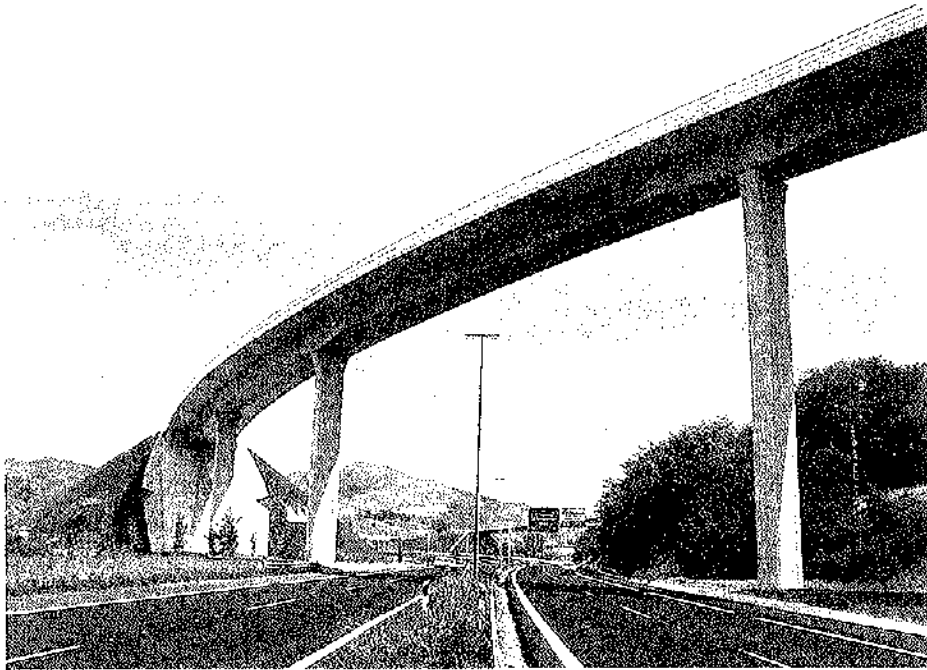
Autovía de Navarra-Guipúzcoa. Viaducto monocelular continuo, de canto variable, ejecutado totalmente, incluso pilas, con elementos prefabricados de hormigón armado y pretensado. Luz máxima: 54 m.
